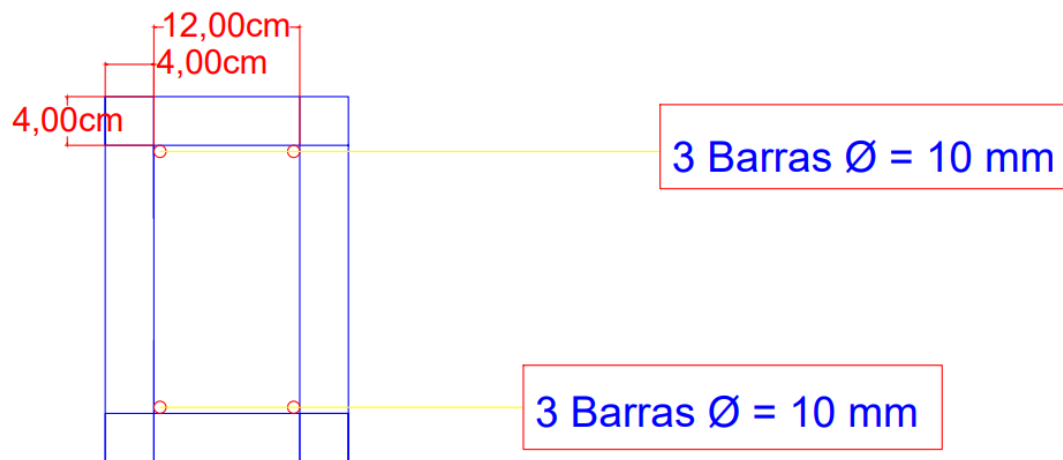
Desenho do detalhamento de armadura longitudinal no pilar utilizando o civil 3D.
